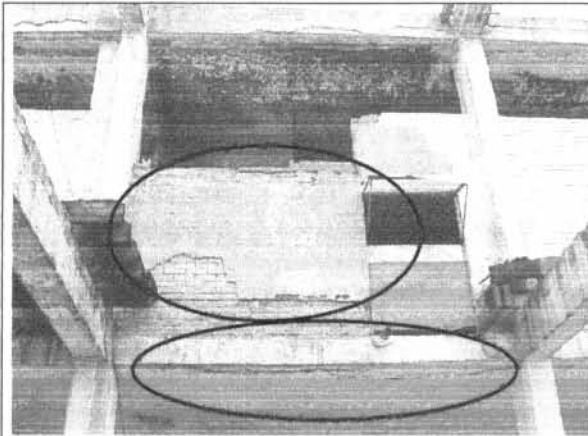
Antepedechos sueltos de la estructura principal y fisuras por exceso de deformación en vigas.
